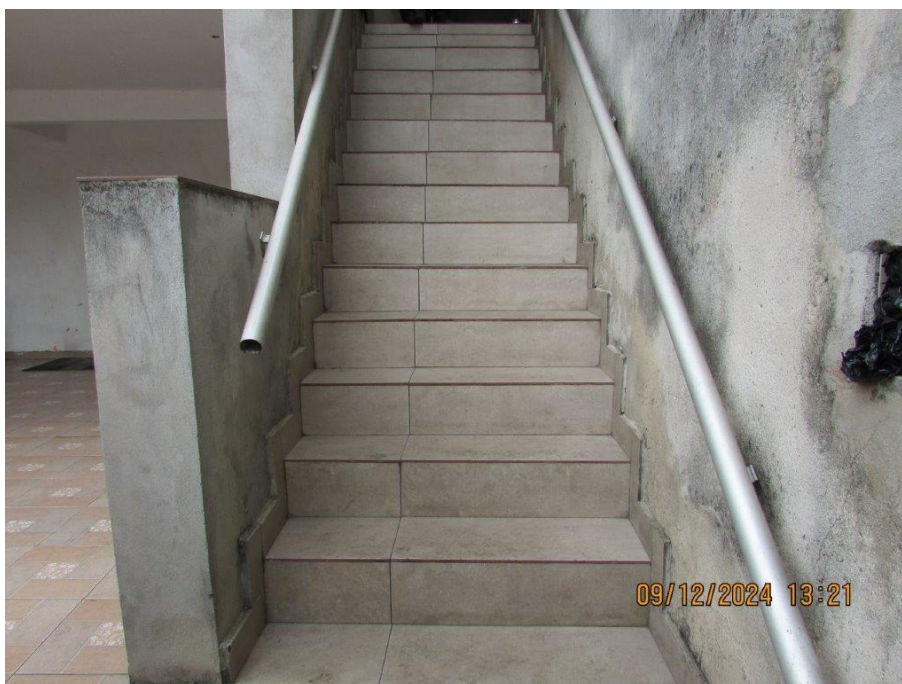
Vista parcial da escada, acesso ao 1º pavimento
